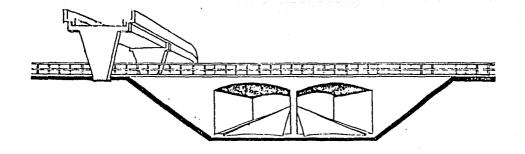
PUENTE DE CONCRETO REFORZADO
